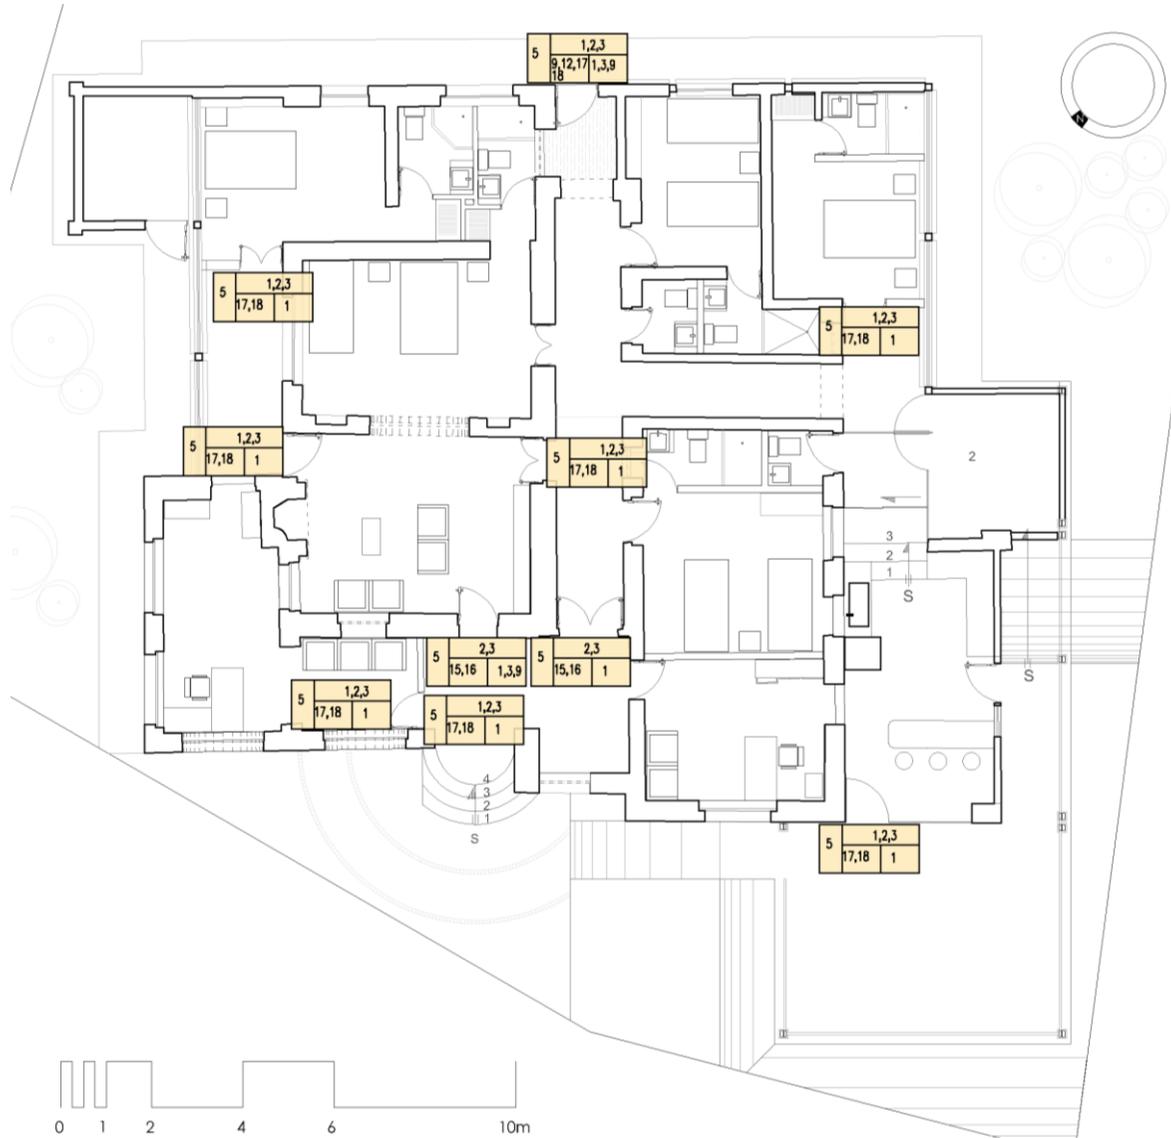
Planta de materiales de cubierta Fuente: Elaboración propia
